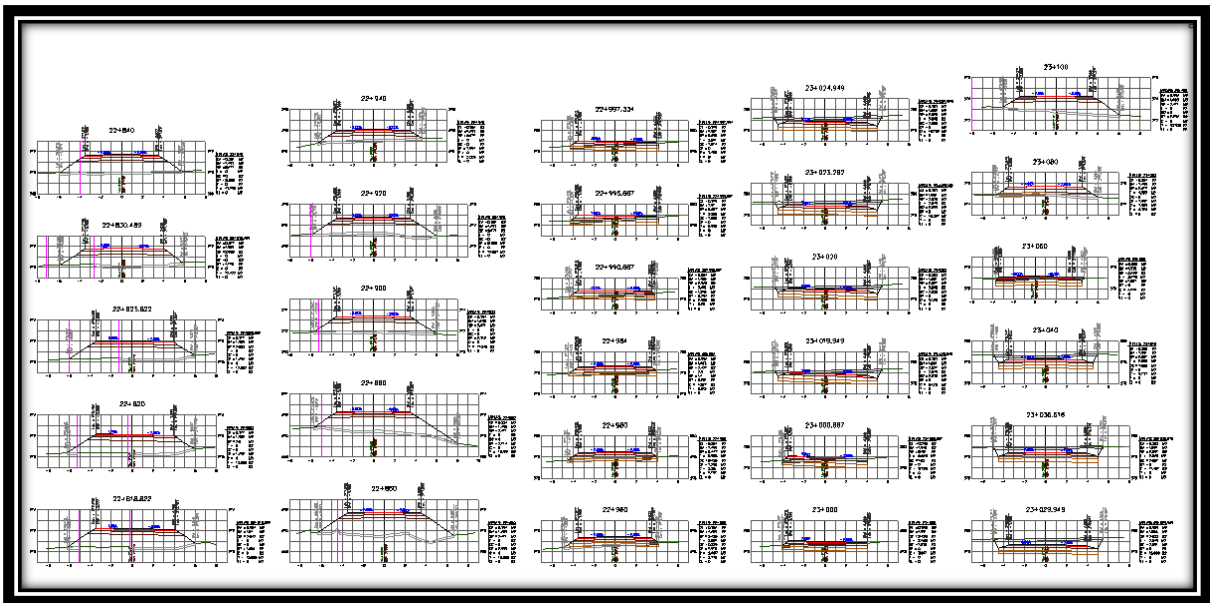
Secciones de construcción del km 22+818.822 al km 23+100.000.
